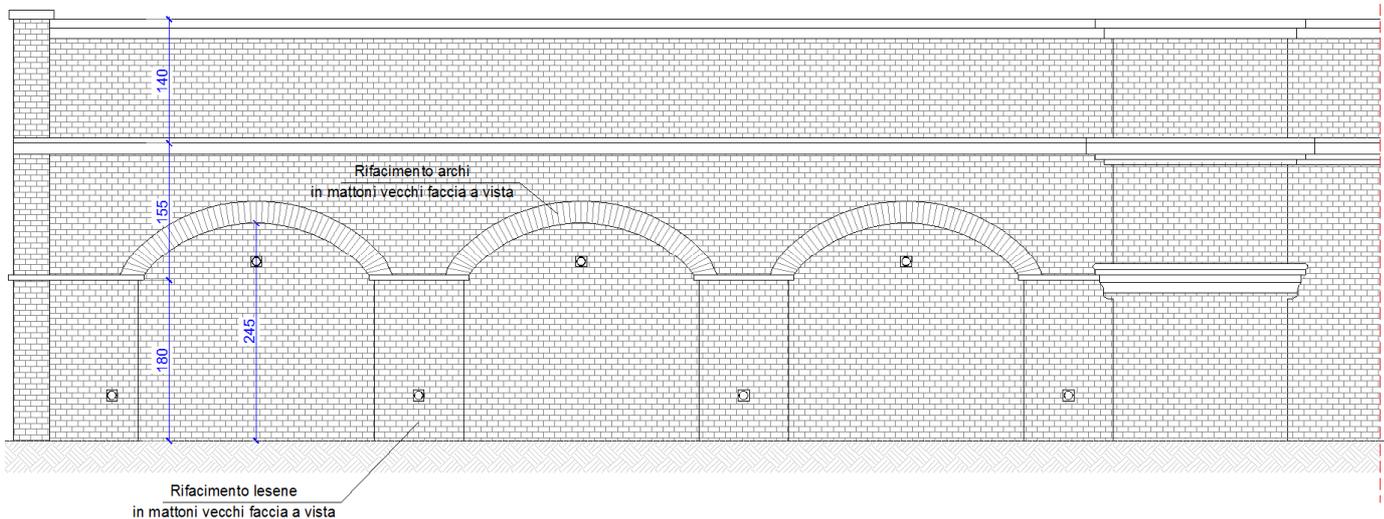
Vista in prospettiva della situazione di progetto del muro di sostegno
